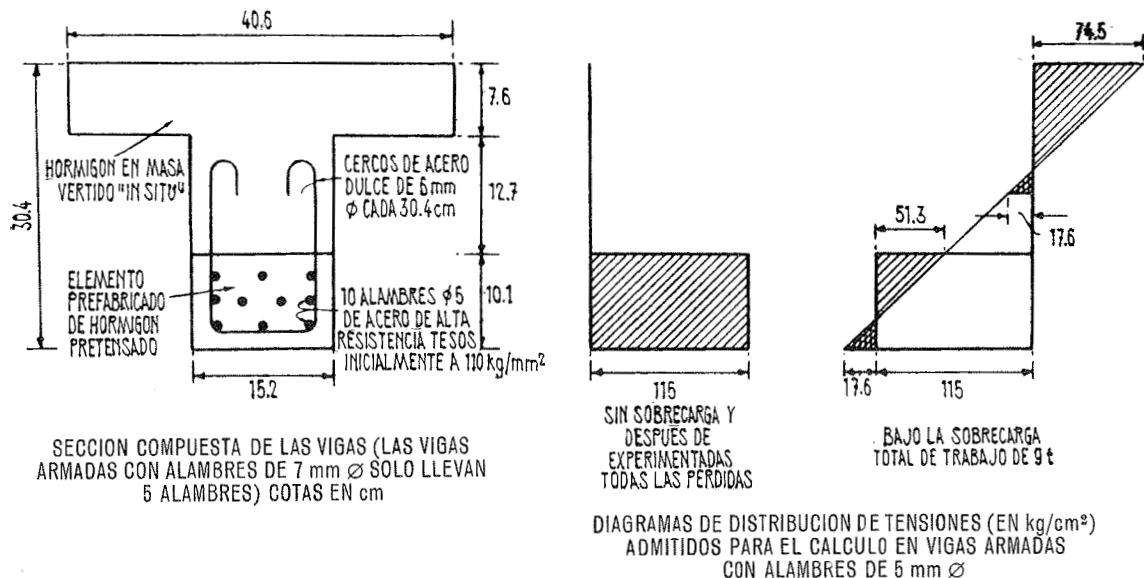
Vigas de hormigón pretensado para los ensayos de fatiga.
